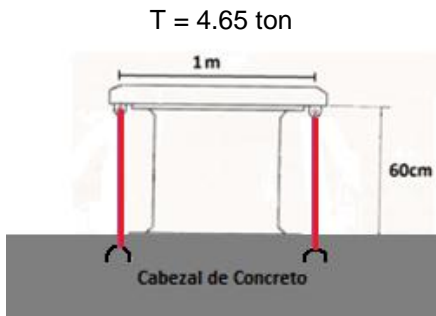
Vista en planta de la defensa en la estructura (Fuente: del Autor)
